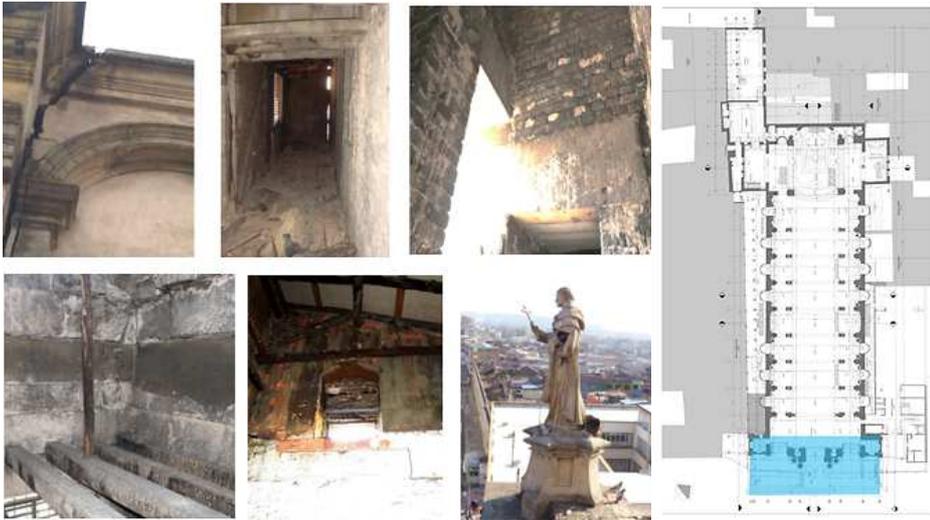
Estado actual de la fachada y contrafachada de la Basílica
